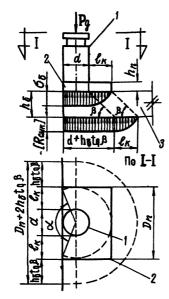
У.7. Расчетная схема стальной спорной плиты на двухслоймом эсновании при расположении домкрата у края стены:
